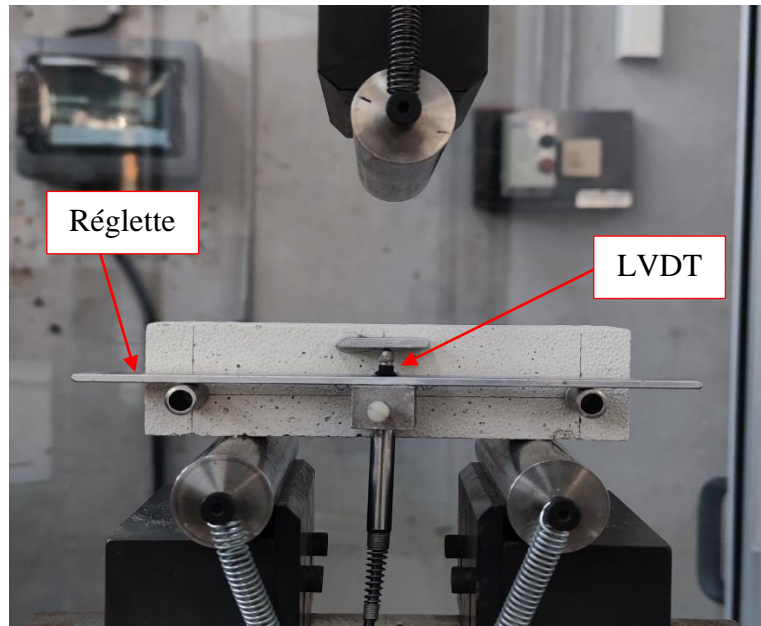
Dispositif de l'essai de flexion sur éprouvettes 4×4×16
